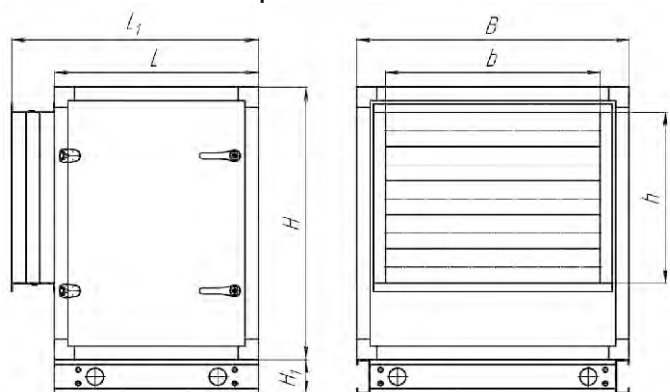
Габаритные и присоединительные размеры. Блок с вертикальным клапаном.
